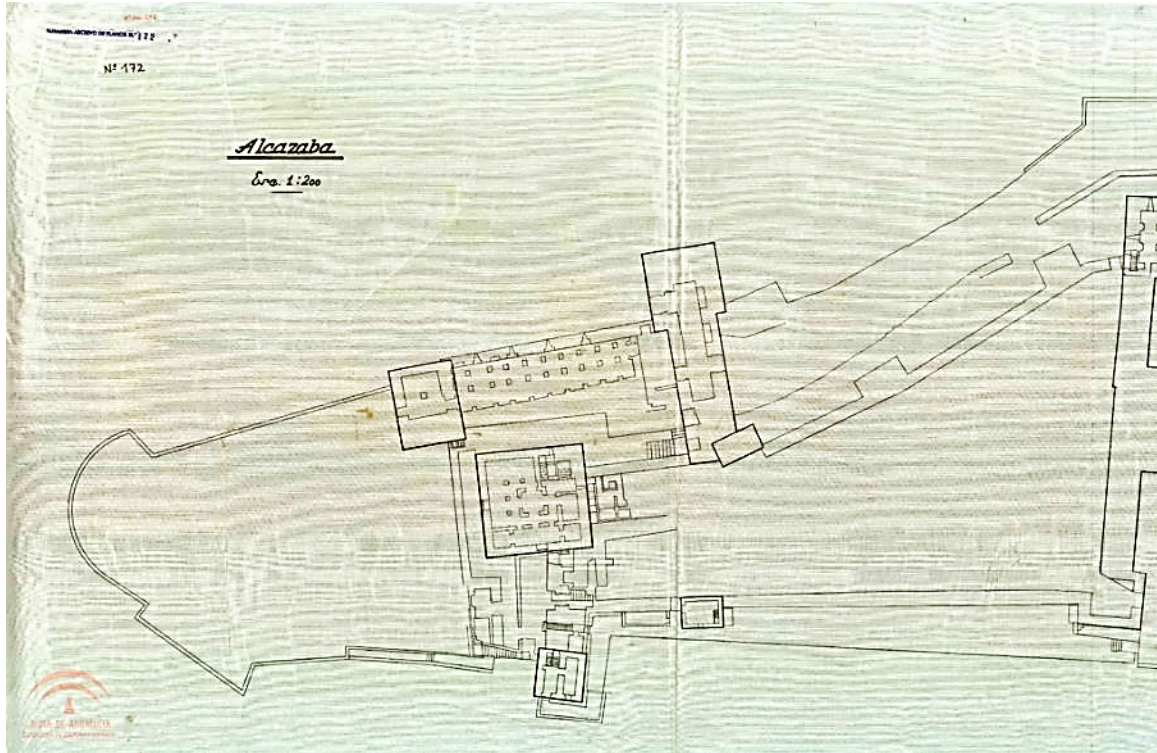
Plano de la Alcazaba de Modesto Cendoya
